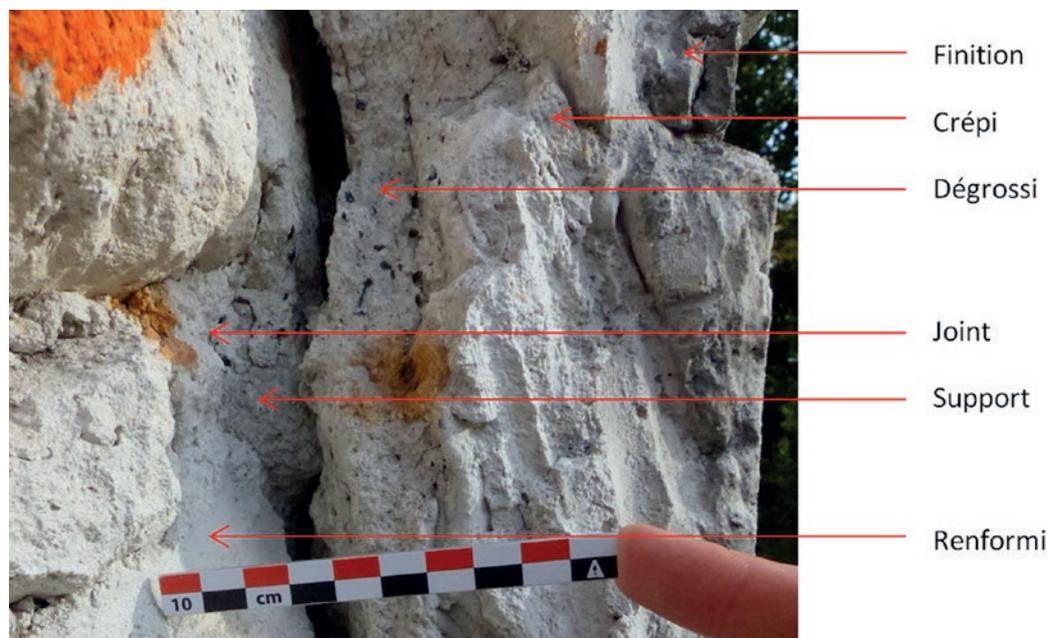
Succession des couches de plâtre sur une épaisseur de 13cm, façade Ouest du Château de Goussainville. Source : Tiffanie Le Dantec.
